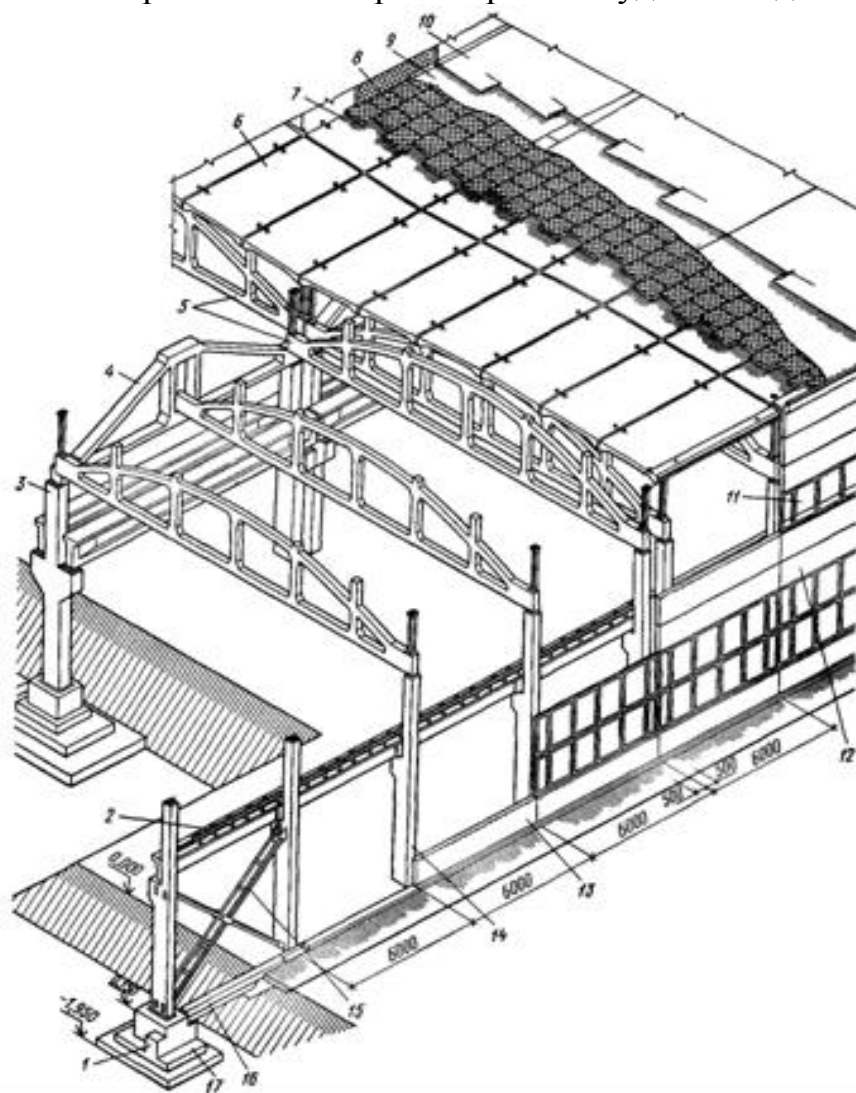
Основні частини будівлі: 1 — бетонний підлив для встановлення фундаментних балок, 2 — підкранова балка, 3 — колона середнього ряду, 4 - підкрівля залізобетонна ферма, 5 - залізобетонна ферма без розкосів, 6 - залізобетонна плита покриття, 7 - пароізоляція, 8 - тепло ізолюючий шар, 9 - цементне стяжка, 10 - багатошаровий руберойдовий килим, 11 — конструкція скління, 12 - стінна панель, 13 — цокольна стінна панель, 14 — колона крайнього
